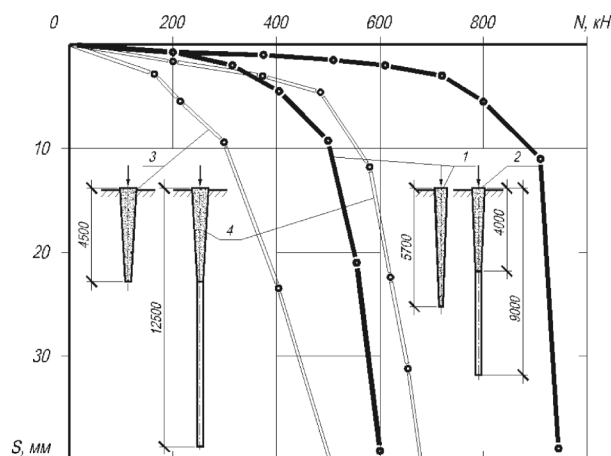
Результаты испытаний опытных свай на вертикальную нагрузку:
